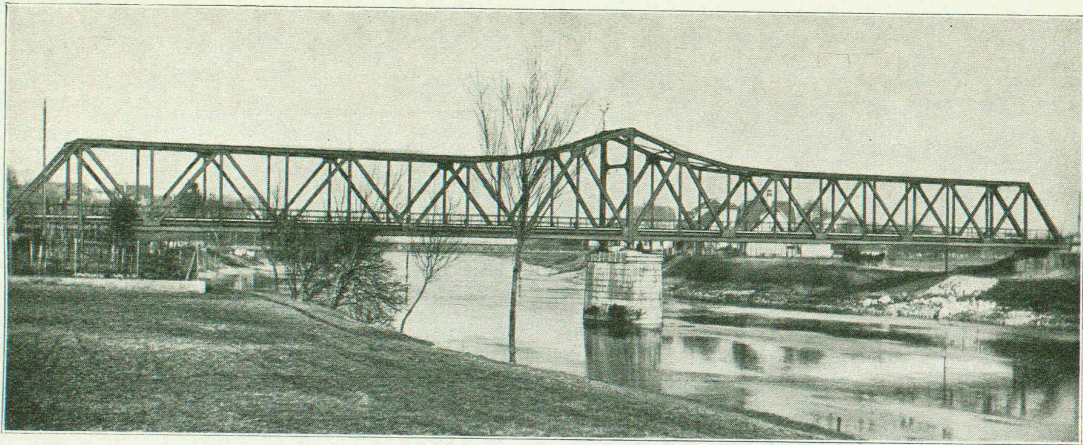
Pont-rail sur l'Aar, près de Brügg. Vue d'ensemble.
